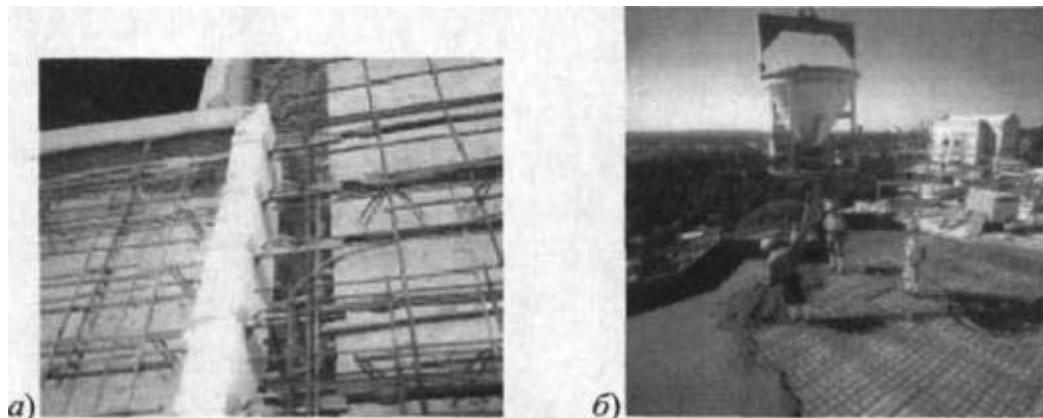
Сборно-монолитные перекрытия с несъемной опалубкой
